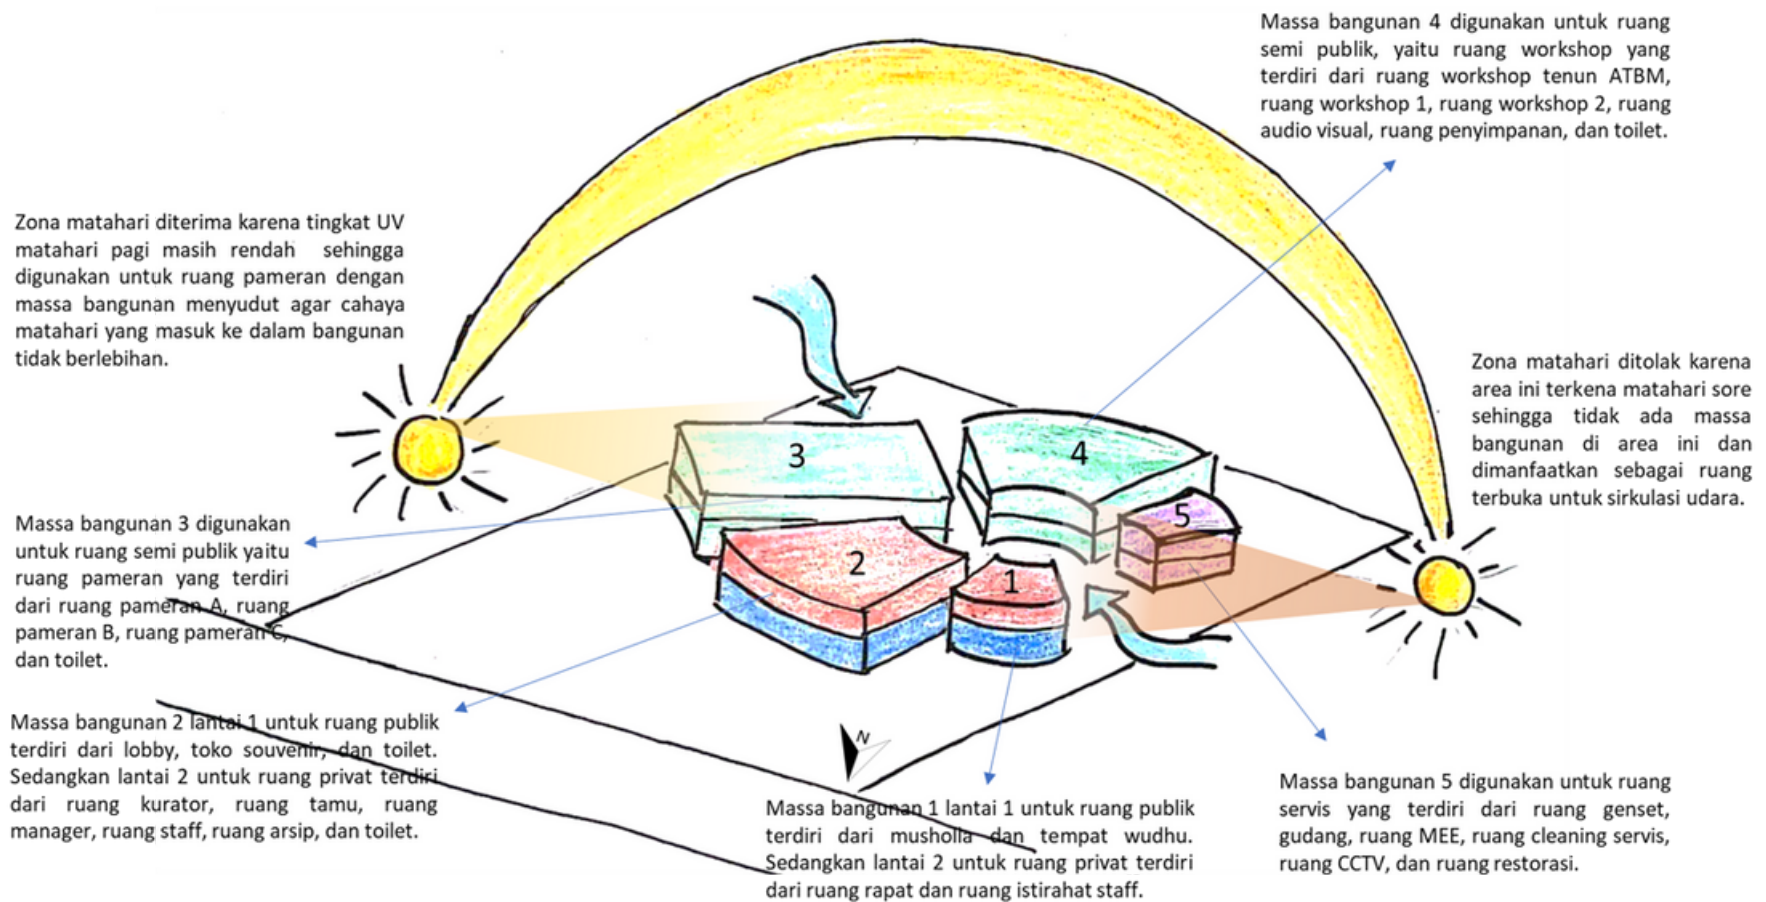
Organisasi Ruang pada Massa Bangunan
